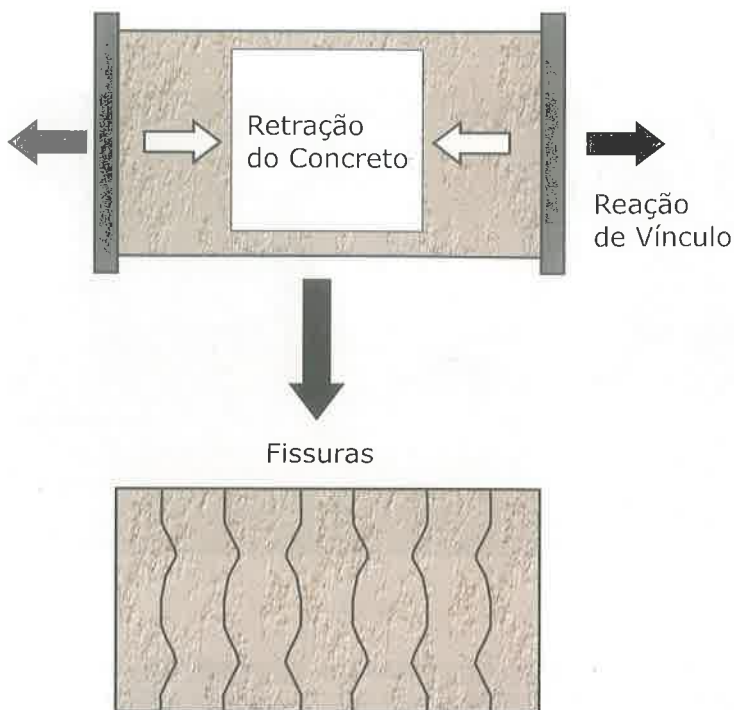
Fissuração devida à retração restringida
